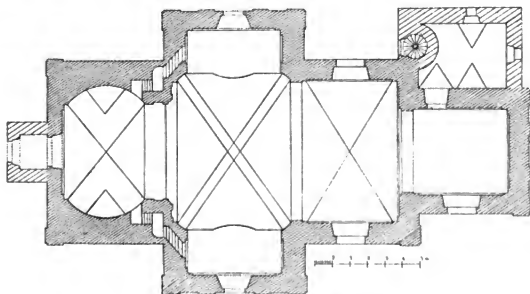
Zbiroh Stadt. Grundriss der Kirche.
